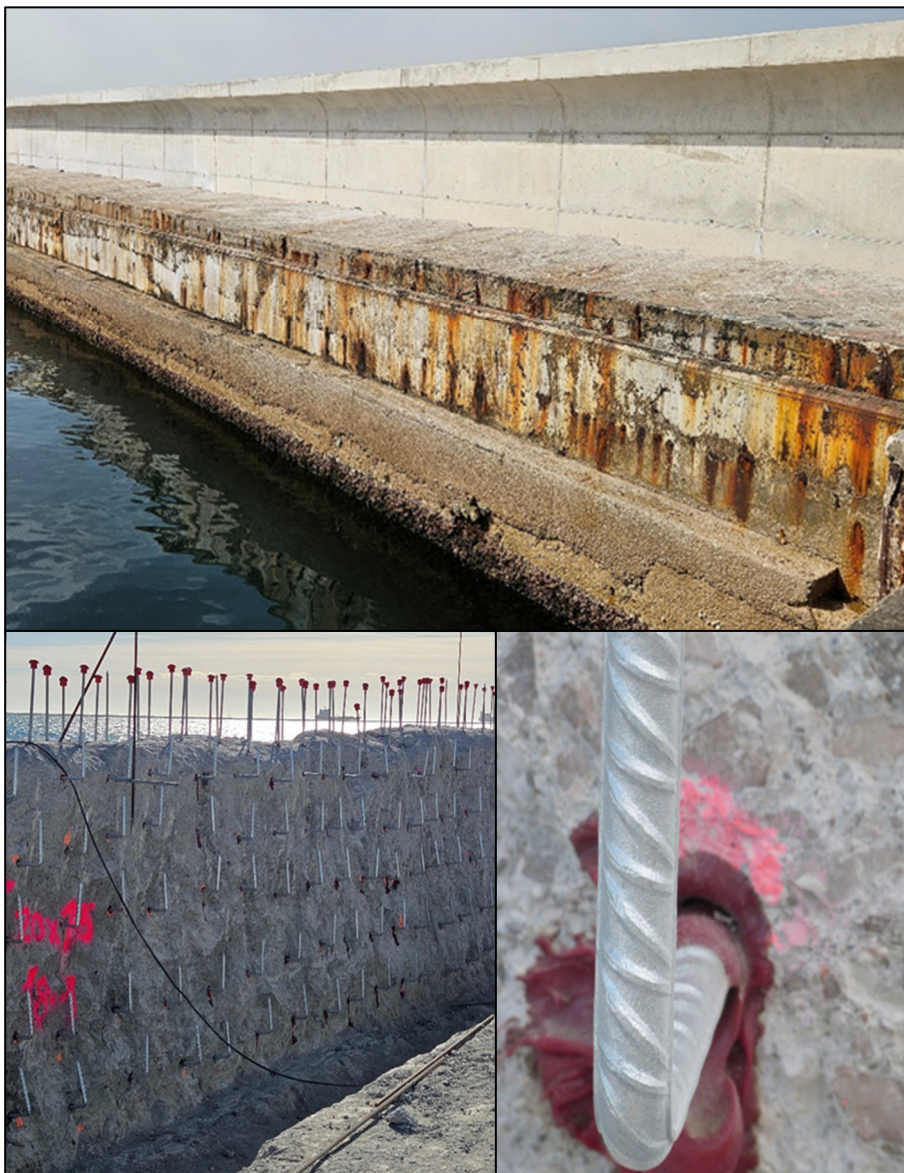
Arriba, vista exterior del espaldón reconstruido; abajo, conectores galvanizados anclados en el hormigón original
